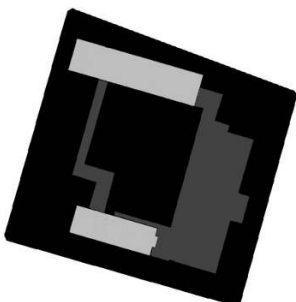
Esquema da planta de implantação da Escola Secundária Jácome Ratton, em Tomar.
